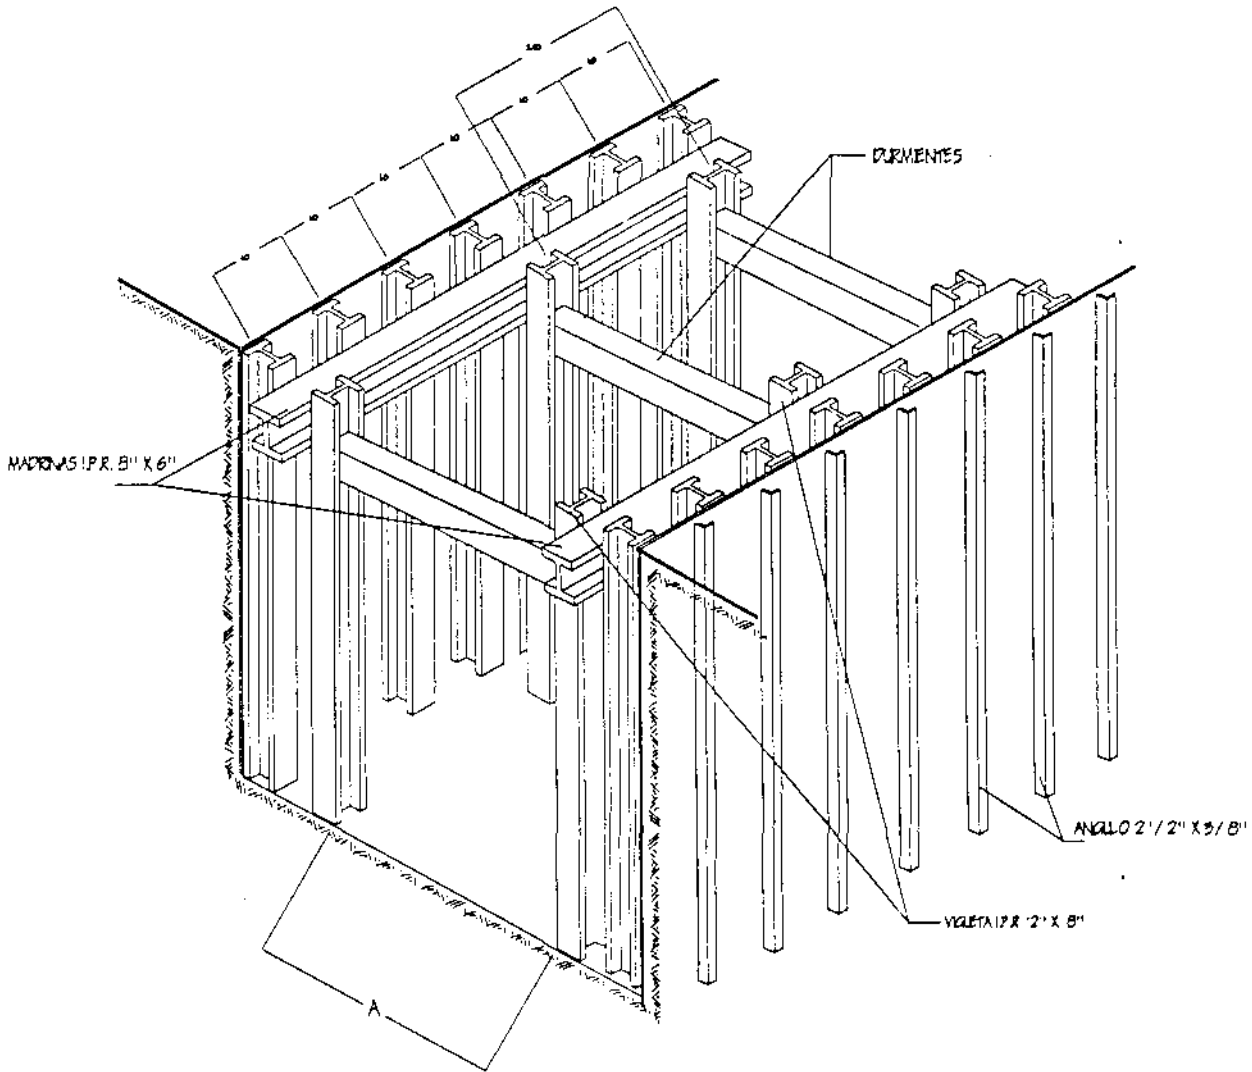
CONSTRUCCION DE ADEME METALICO
